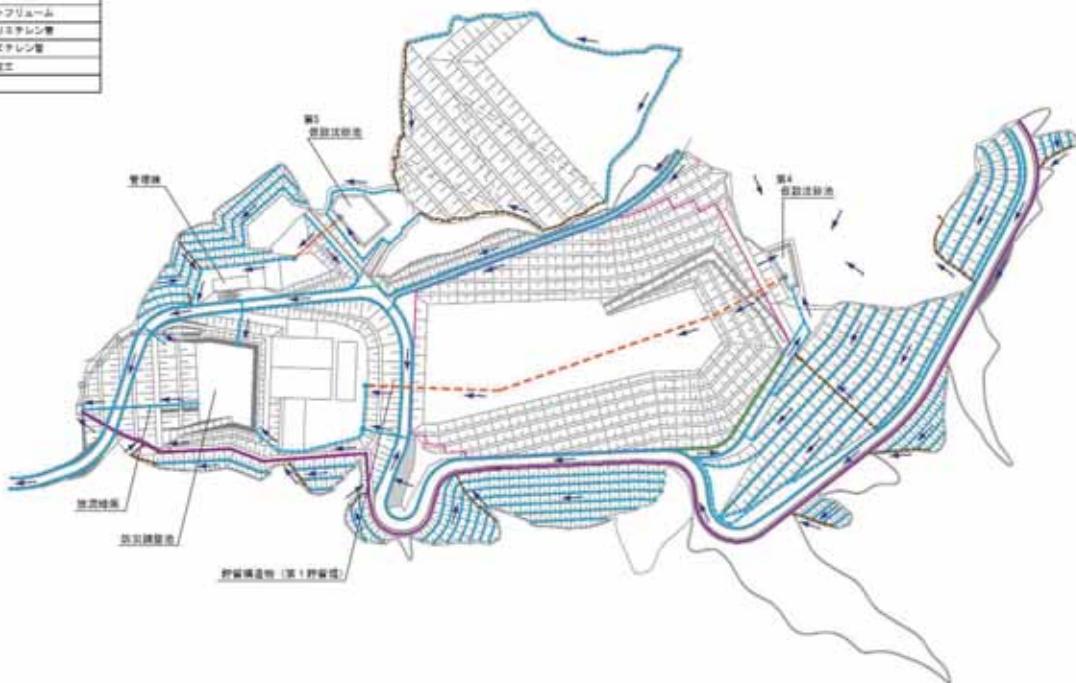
雨水集排水施設配置図 埋立地周辺（第 1 期整備）
